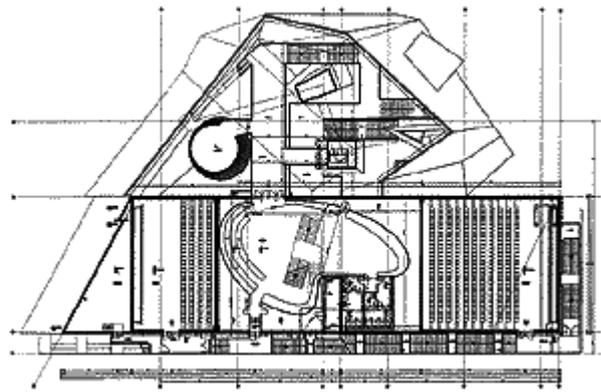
Planta - FONTE: COOP HIMMELB(L)AU.
